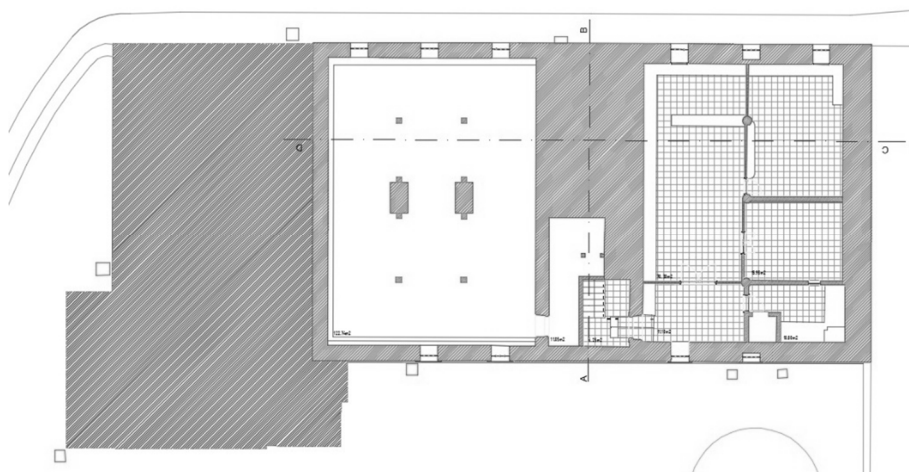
Planta da Cave (s/escala) – (Autor)
